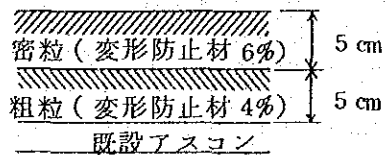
4 - 2 試験施工の標準的な舗装断面図
